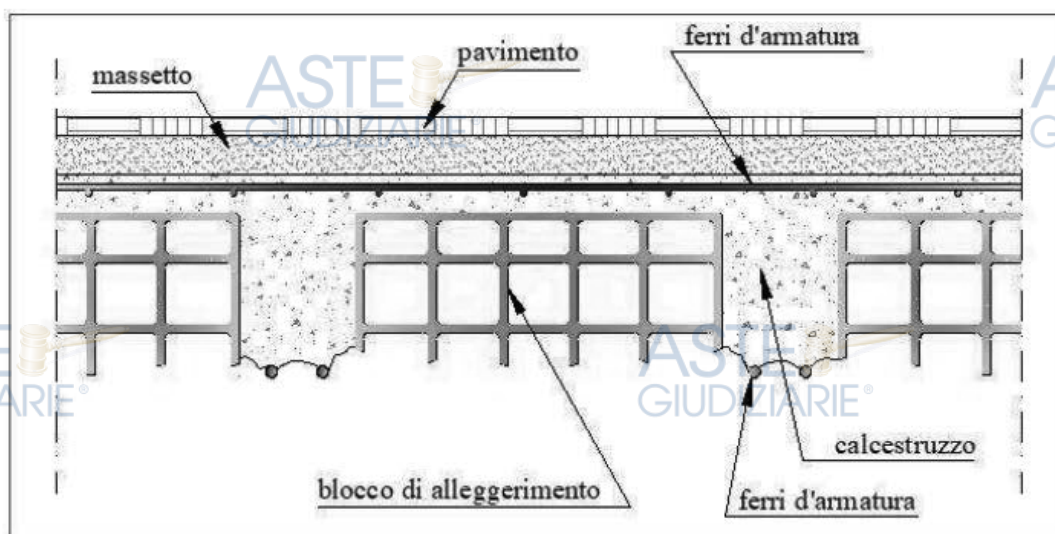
Sezione tipica di un solaio in laterocemento: schematizzazione del fenomeno.
